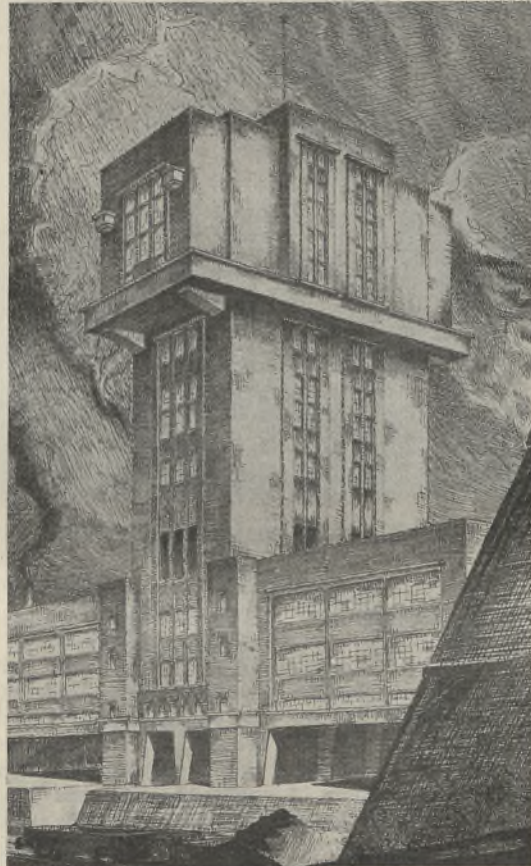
Ansicht des neuen Förderturms mit Maschinenhaus und Schachtkäue.
